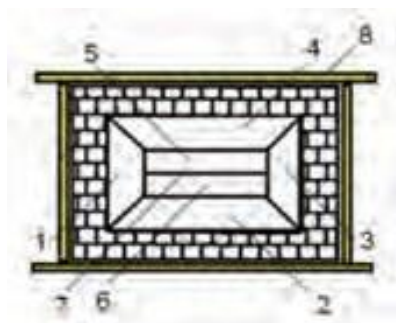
План безопасного обрушения конструкции ограждения здания.
